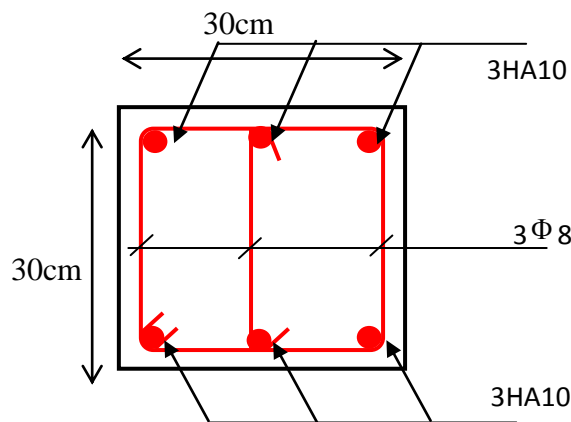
Schéma de ferrailage de la poutre de chaînage.
